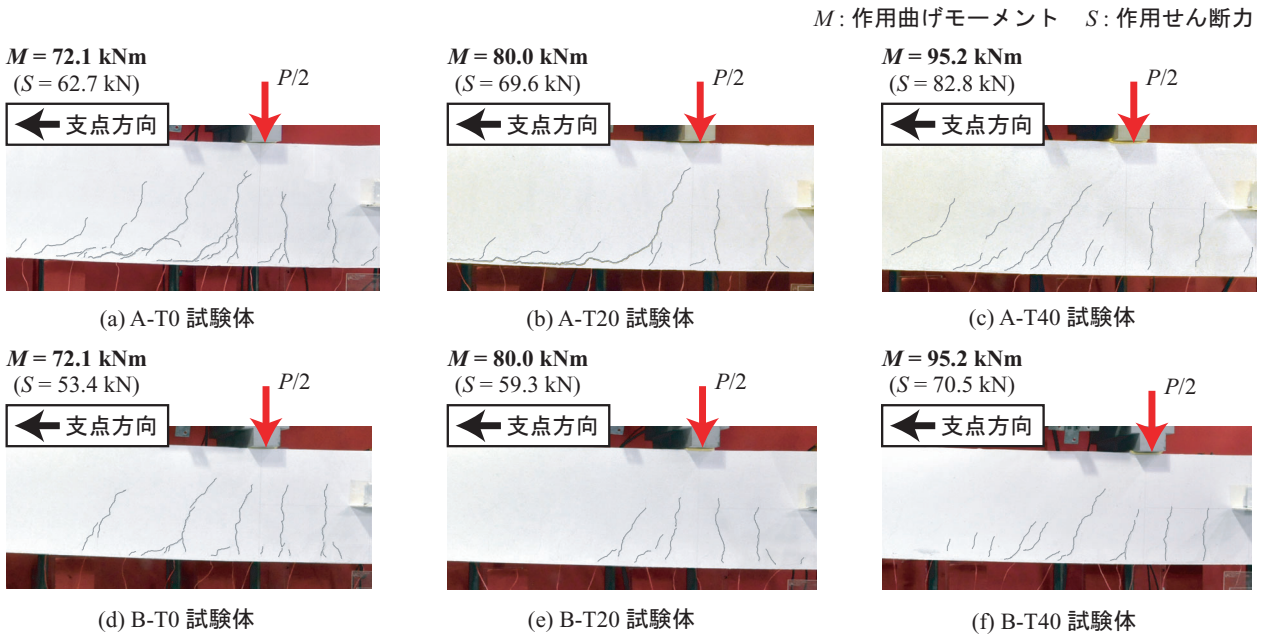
同一作用曲げモーメント時におけるひび割れ性状
